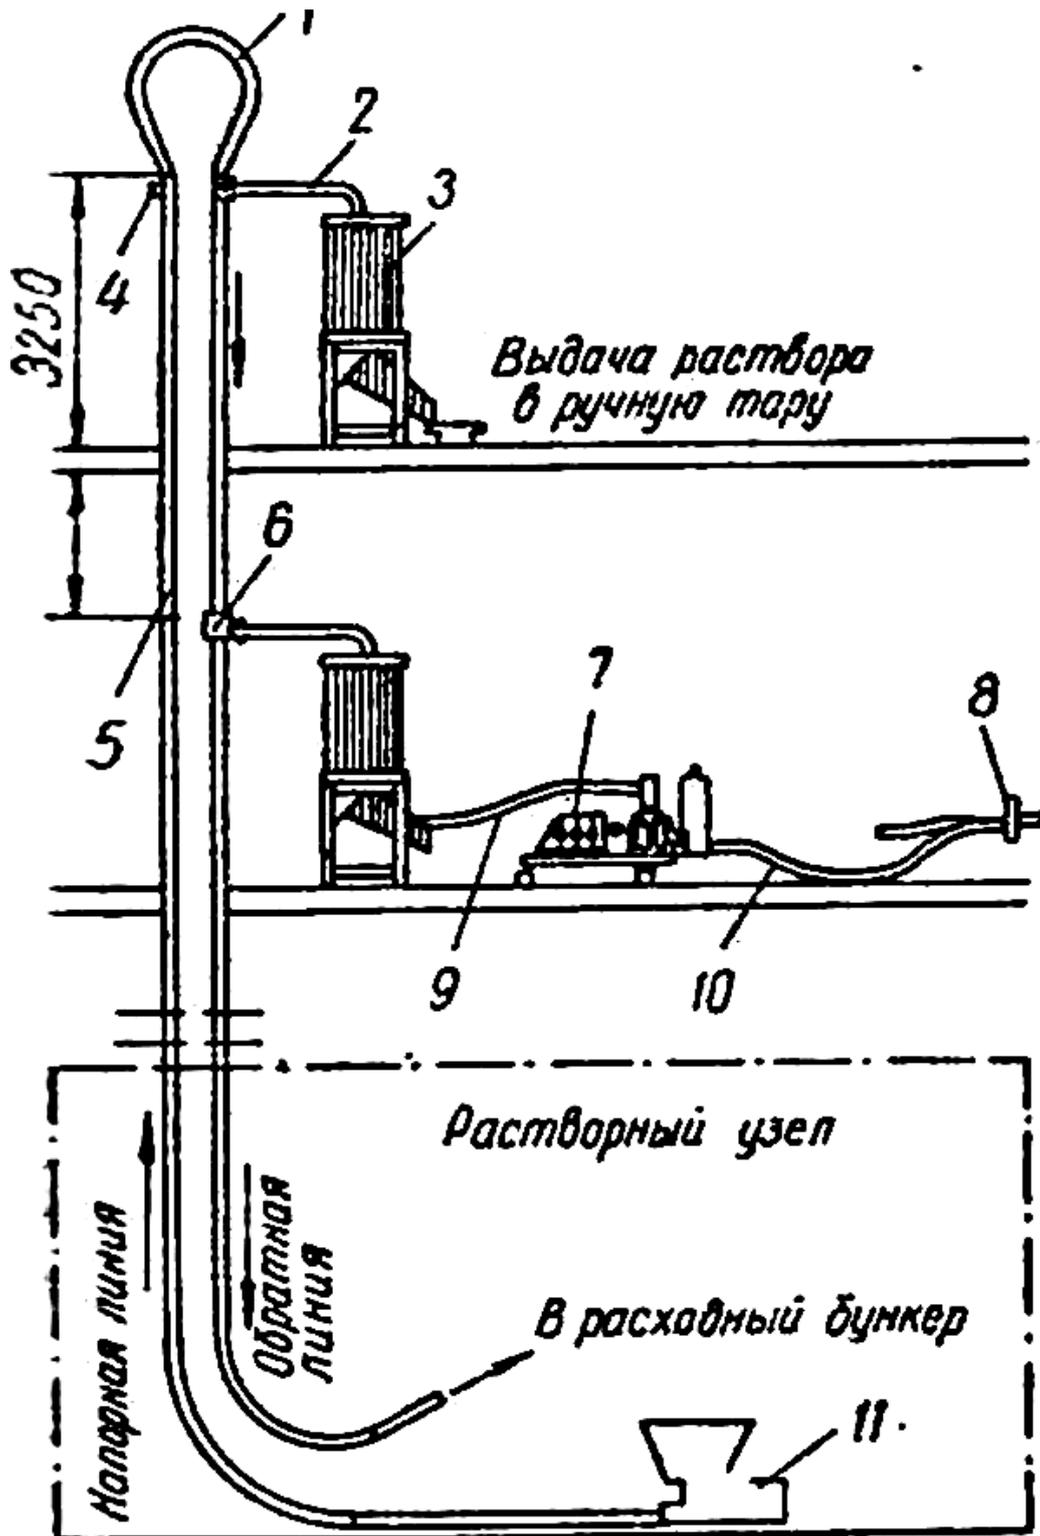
Схема подачи раствора в поэтажные бункеры по инвентарному растворопроводу: 1 – инвентарный растворопровод; 2 – шланг; 3 – поэтажный бункер; 4 – заглушка; 5 – стыковое соединение труб; 6 – кран трехходовой; 7 – поэтажный растворонасос; 8 – сопло штукатурное; 9, 10 – шланги; 11 – растворонасос
